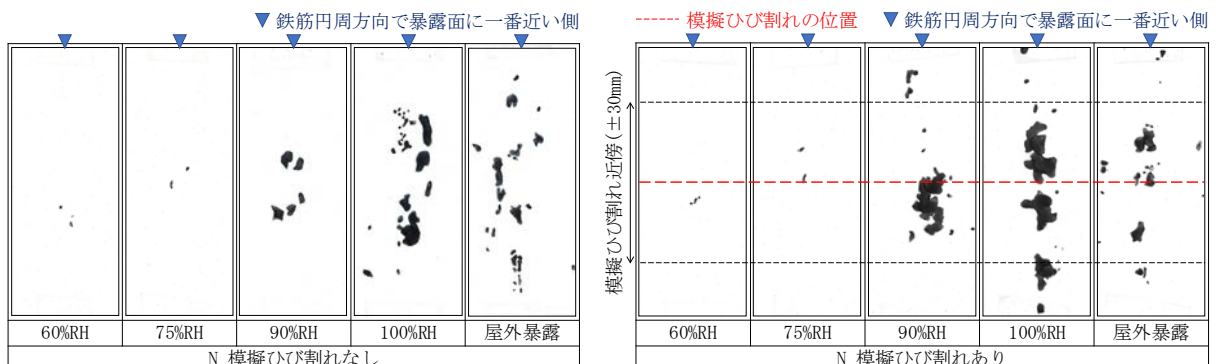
暴露試験終了時の鉄筋表面の鉄筋腐食箇所のトレース結果 (N/模擬ひび割れなし, あり)
